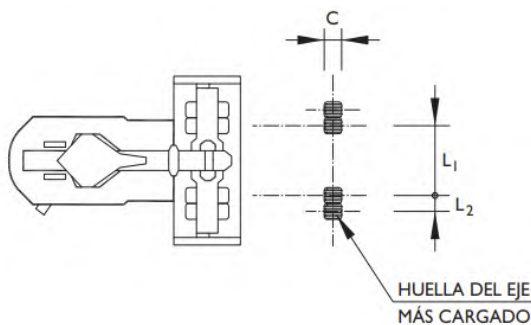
Esquema de aplicación de cargas al pavimento sobre en eje delantero en hipótesis de carga máxima. Fuente: ROM 2.0-11, tabla 4.6.4.15.
